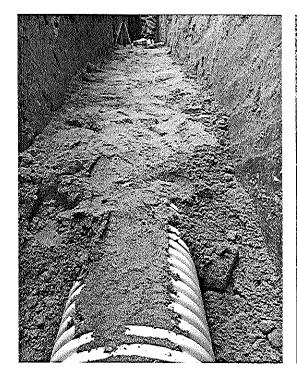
y 37. Relleno con arena alrededor de tubería sanitaria
